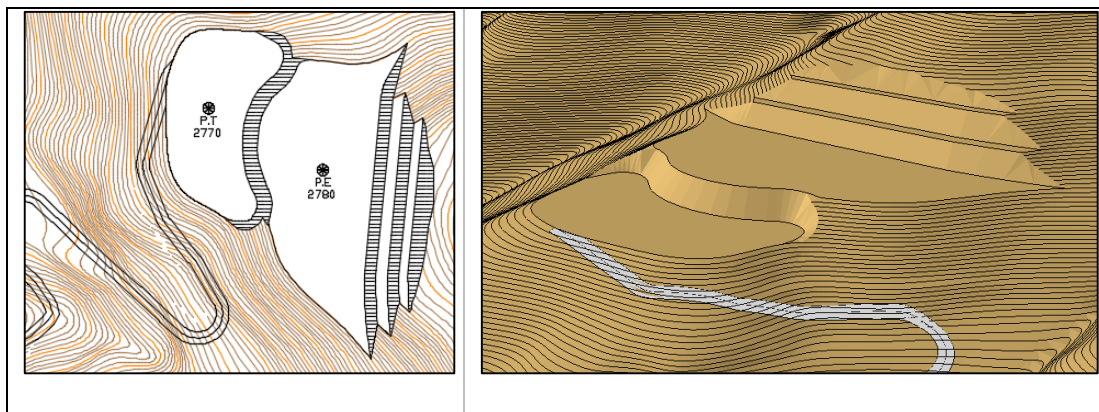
Vista en planta y en 3D de la Fase 3 de explotación.
